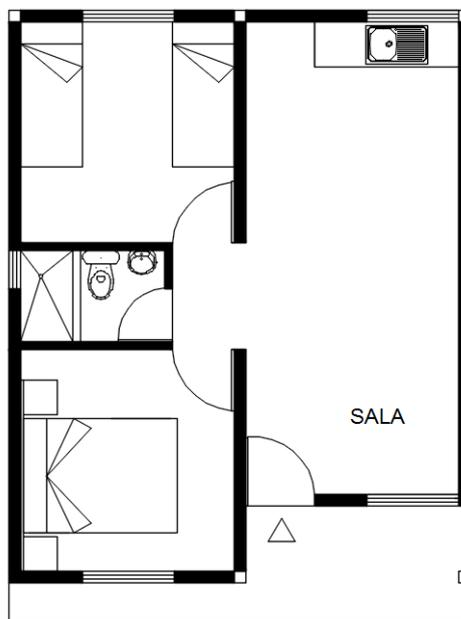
Levantamiento arquitectónico vivienda Manuela Espejo
